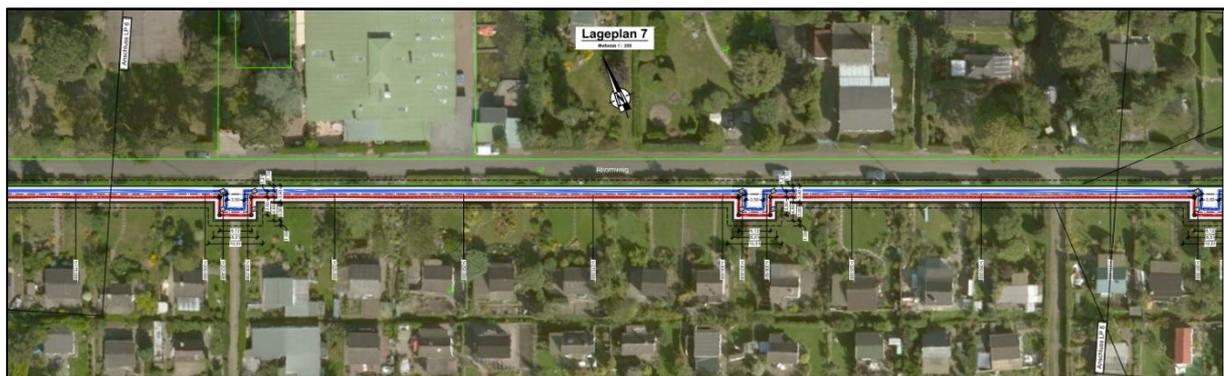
Abschnitt 4 – Ahornweg Plan 2.2.7
